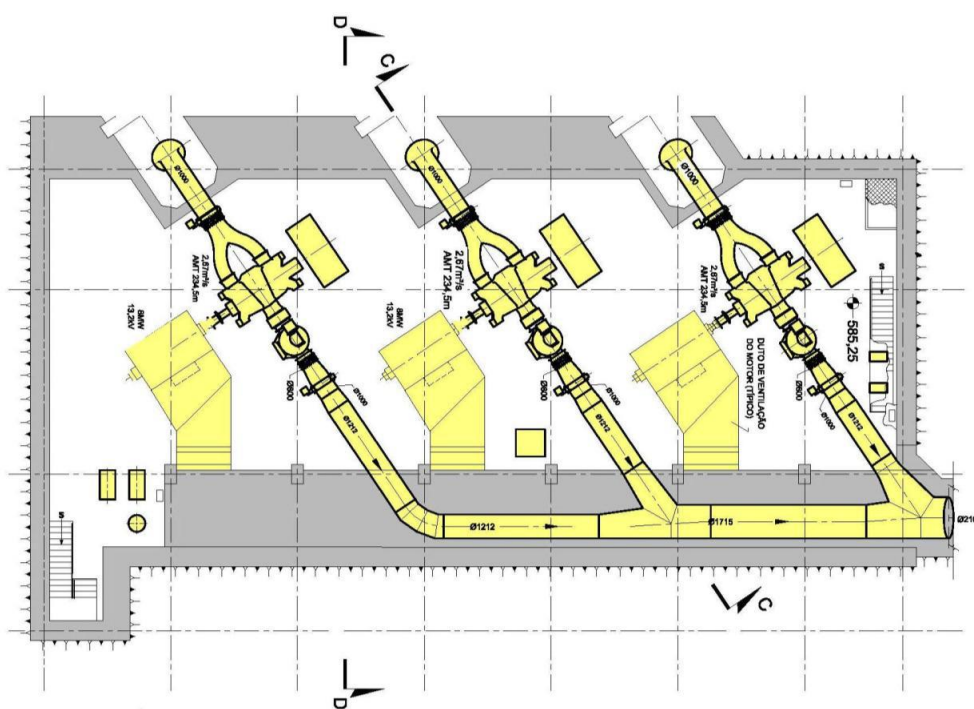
Arranjo da Instalação dos Conjuntos Moto Bombas - Planta
